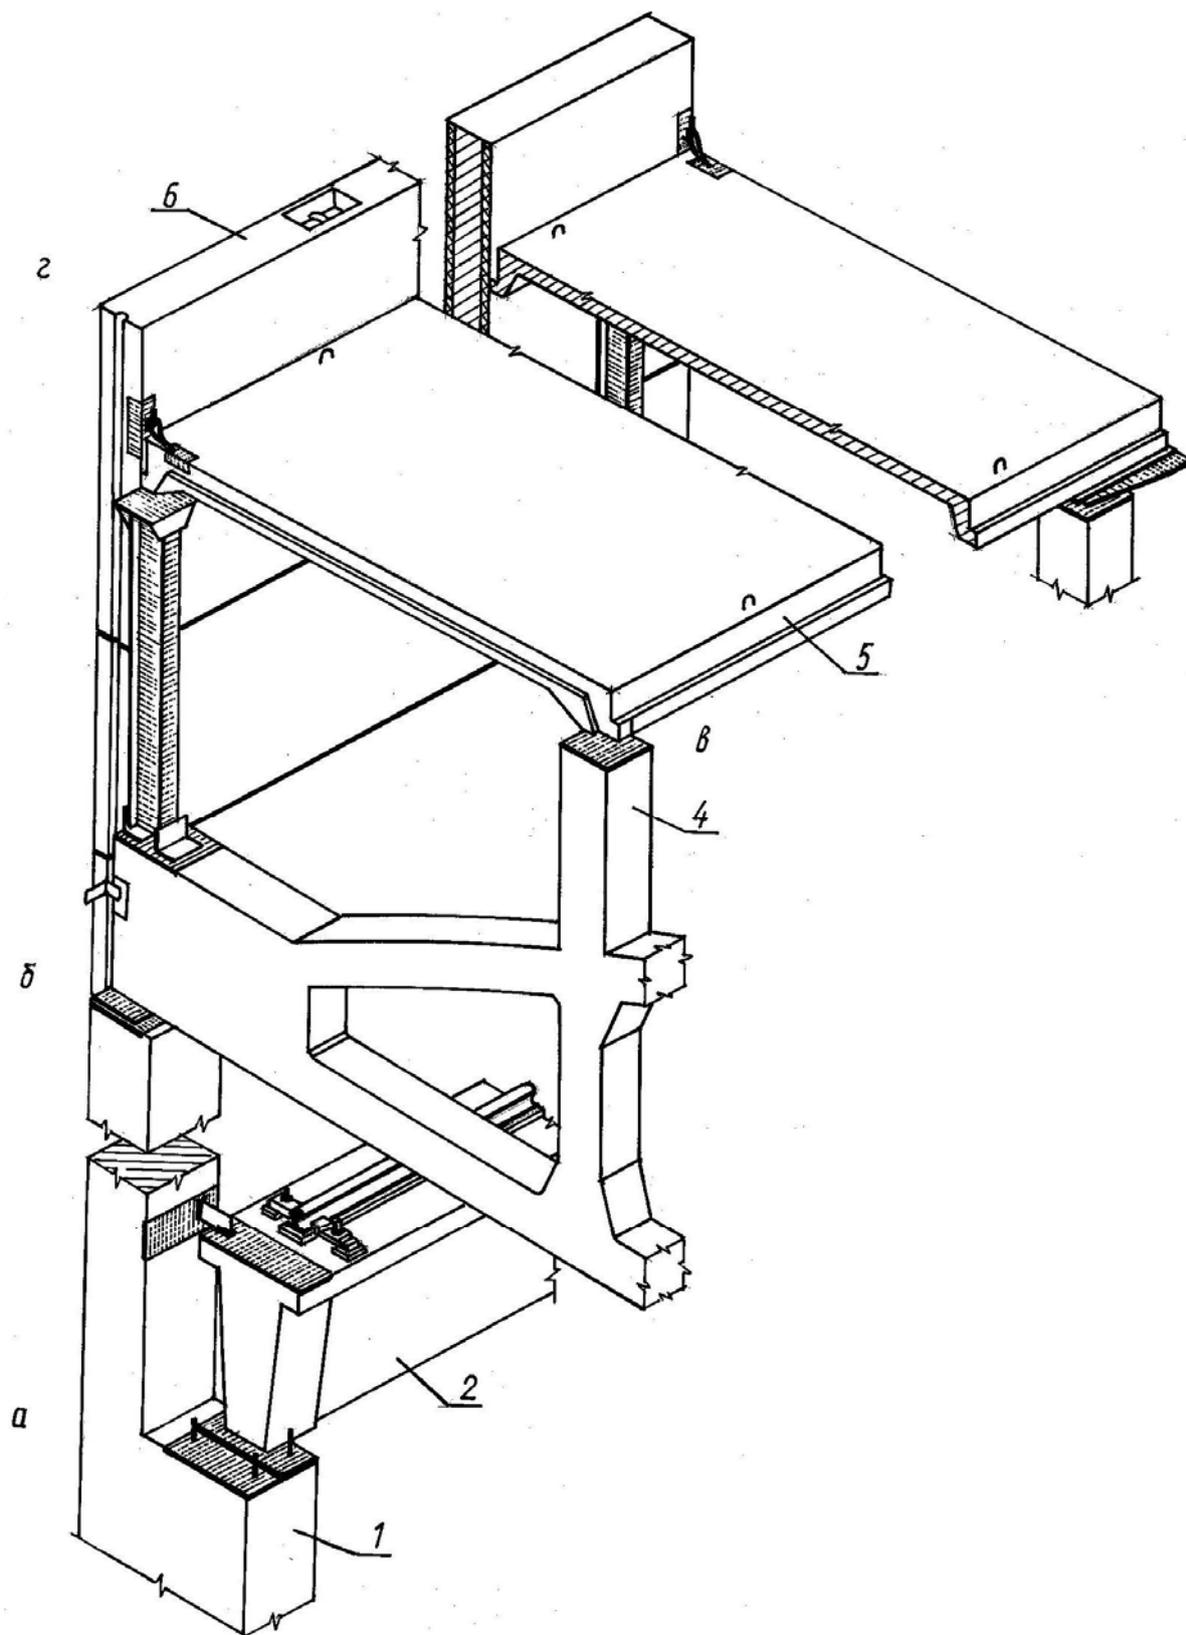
Узлы сопряжения конструкций покрытия с колонной крайнего ряда:
